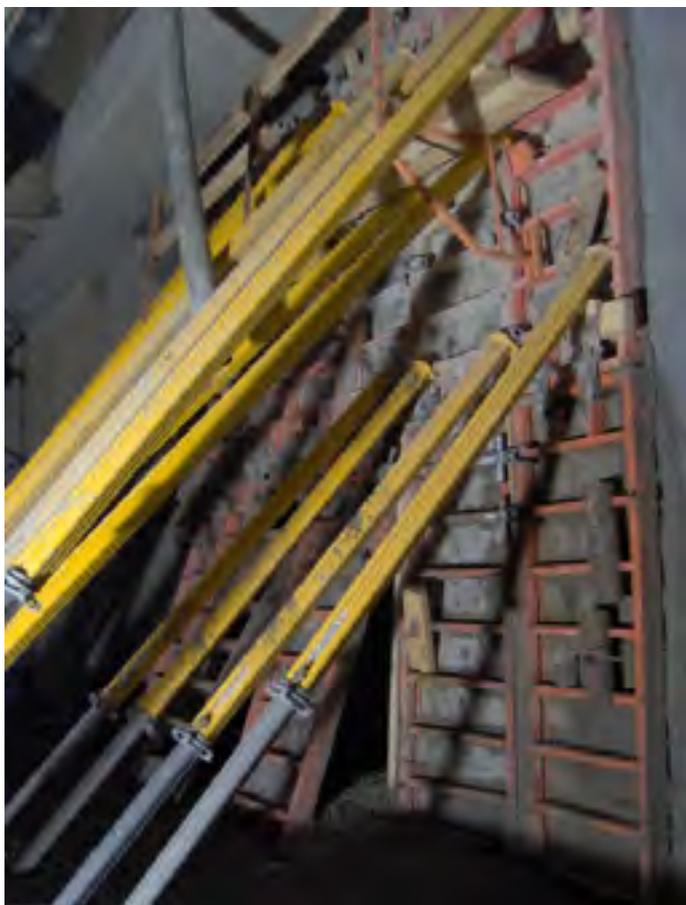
Reventón de encofrado durante el hormigonado del muro.
